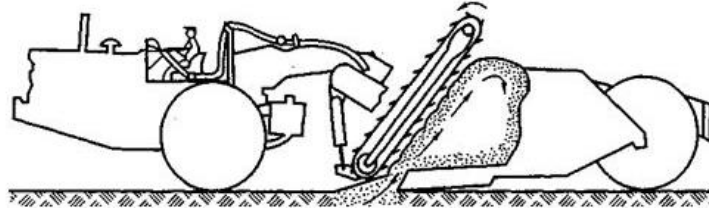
Загрузка ковша скрепера скребковым элеватором
